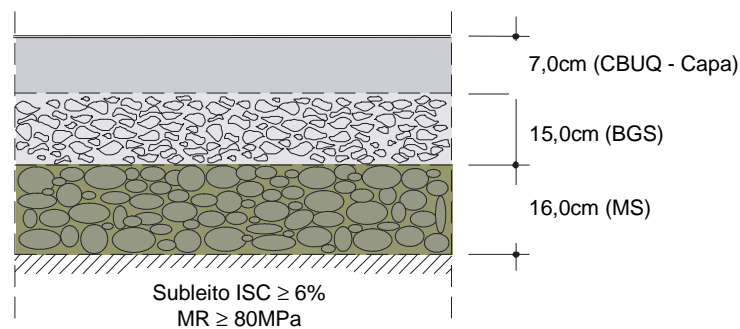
Estrutura de pavimento – Pista de rolamento para ruas laterais
